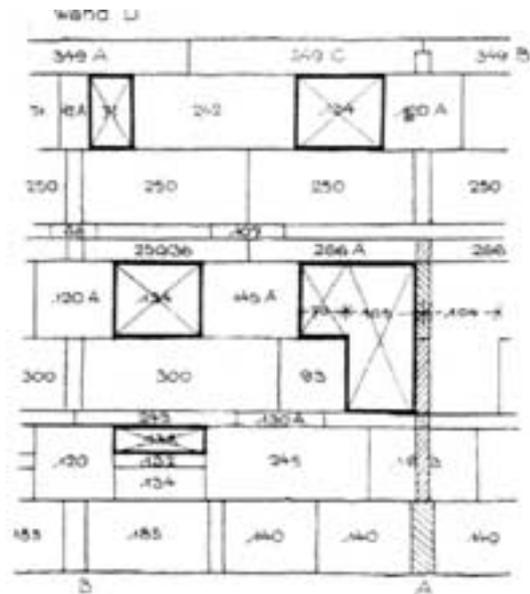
Versatzplan der Wandelemente⁴⁶
